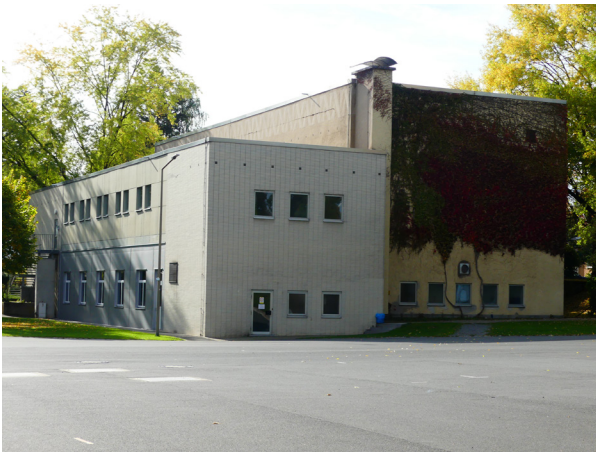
Stadthalle Nordostfassade, Schwimmbad im Untergeschoss
